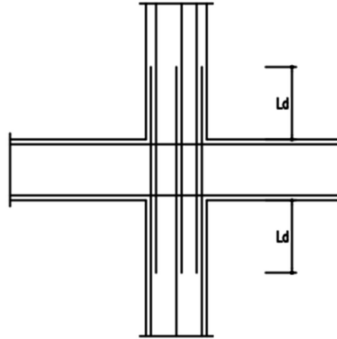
7 Detail Standart penulangan AUTOCAD
